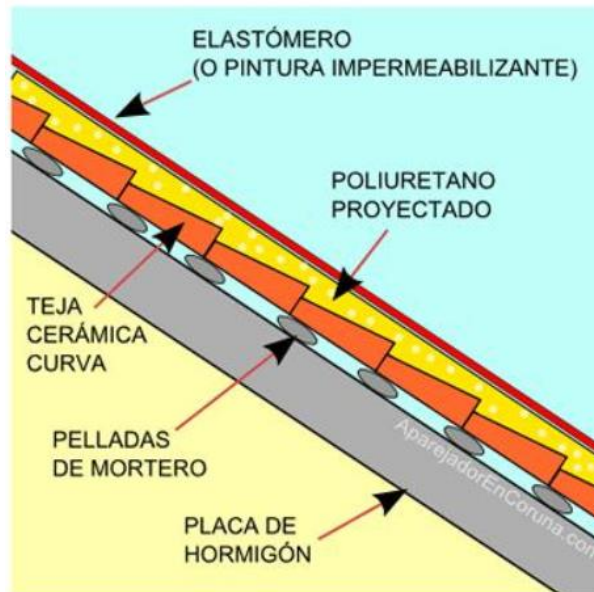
Aislamiento térmico en cubierta inclinada por el exterior. Fuente: (Aparej, 2021)
